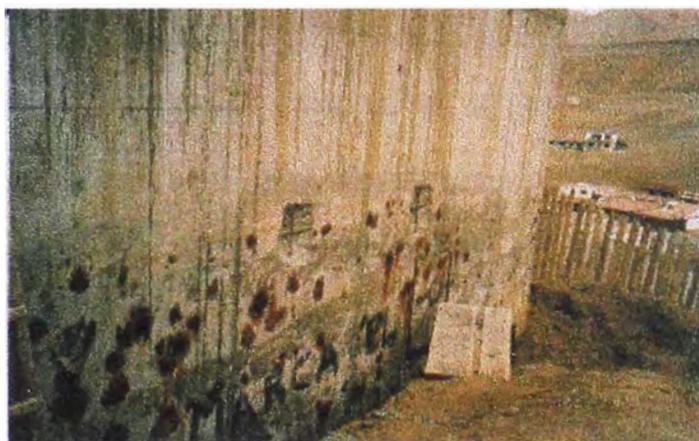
Cara Oeste de los tanques con manchas de óxido y picado para el registro visual de las armaduras.
